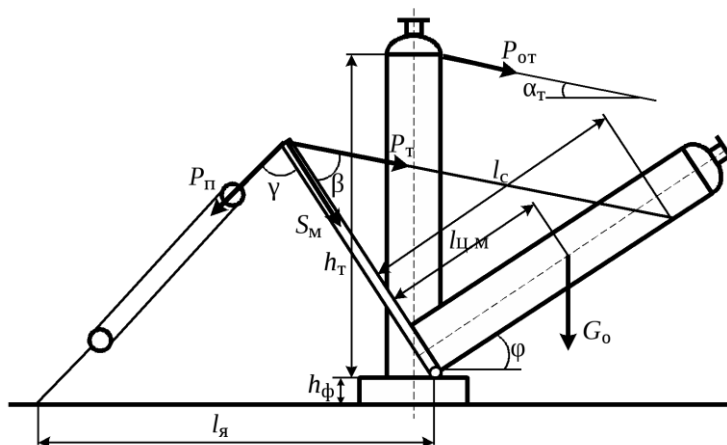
Расчетная схема монтажа оборудования падающим шевром
